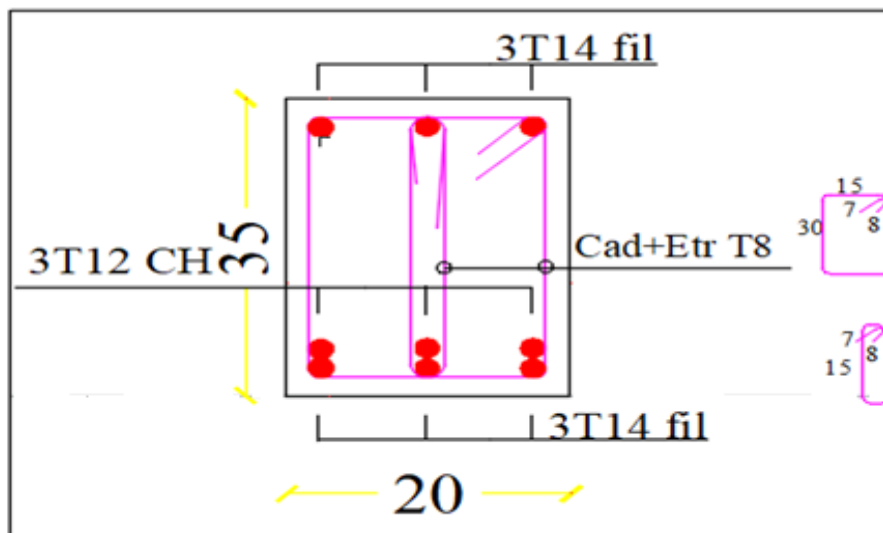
Ferrailage en travée d'une poutre principale.
